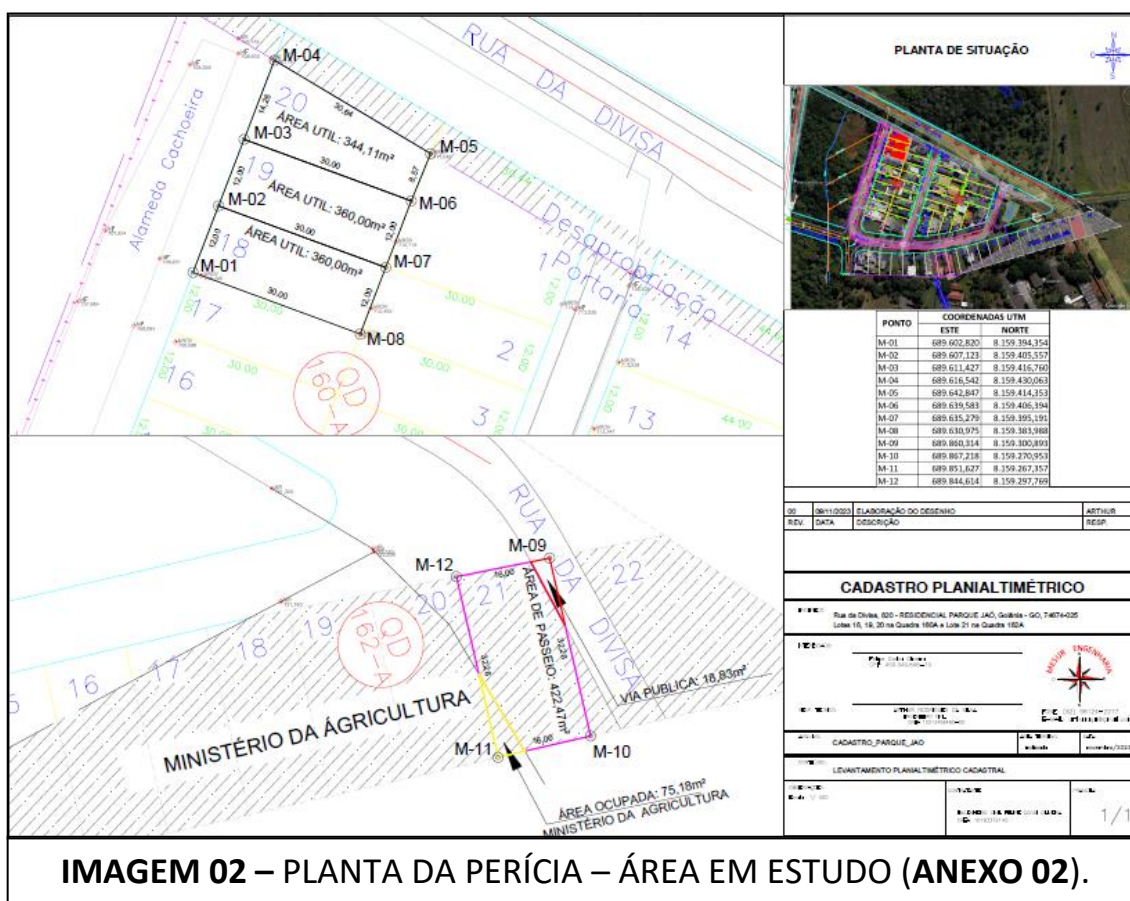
PLANTA DA PERÍCIA – ÁREA EM ESTUDO (ANEXO 02).
